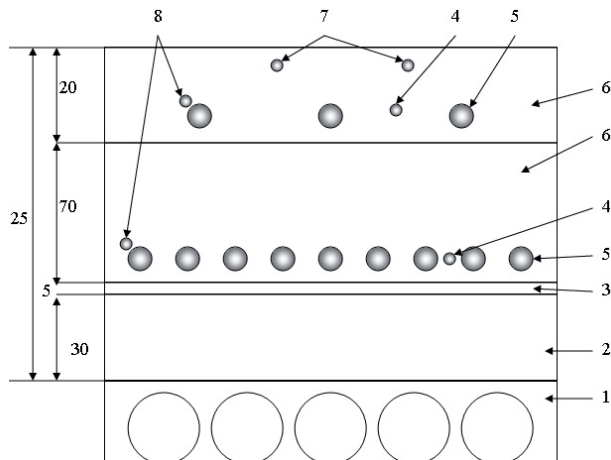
Схема електропідлоги: 1 — плита міжповерхового перекриття; 2 — теплоізоляція; 3 — відображаюча ізоляція; 4 — датчик температури бетонного шару; 5 — опалювальні кабелі; 6 — теплоакмулюючий шар; 7, 8 — датчики температури поверхні бетонного шару і кабелю
